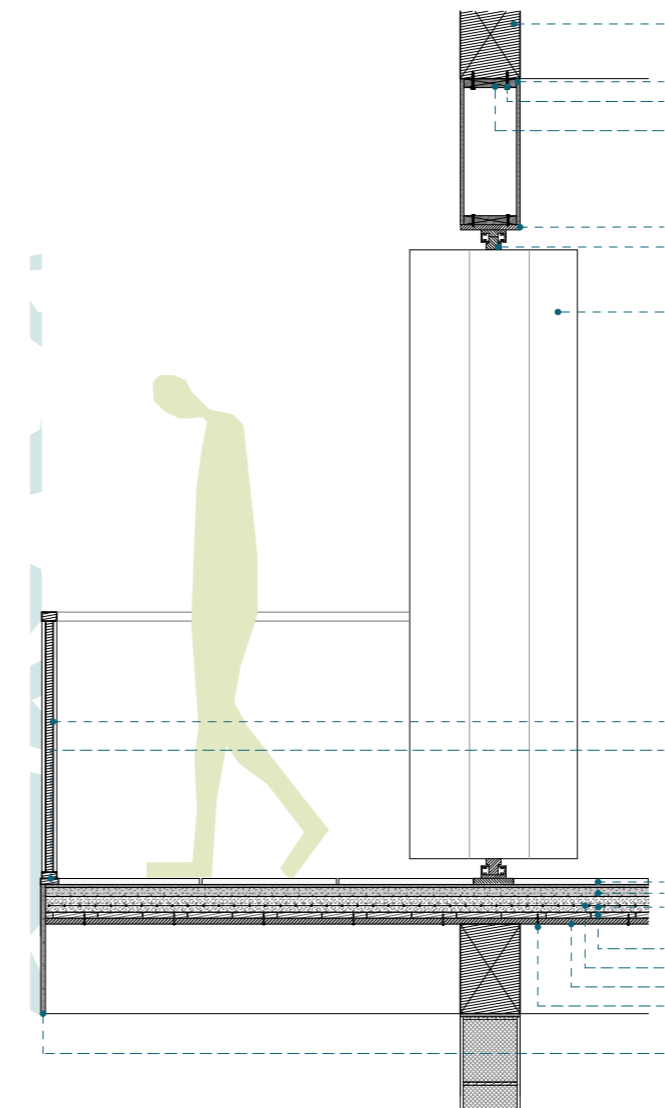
Sección constructiva bloque A. Fuente: Elaboración propia.
